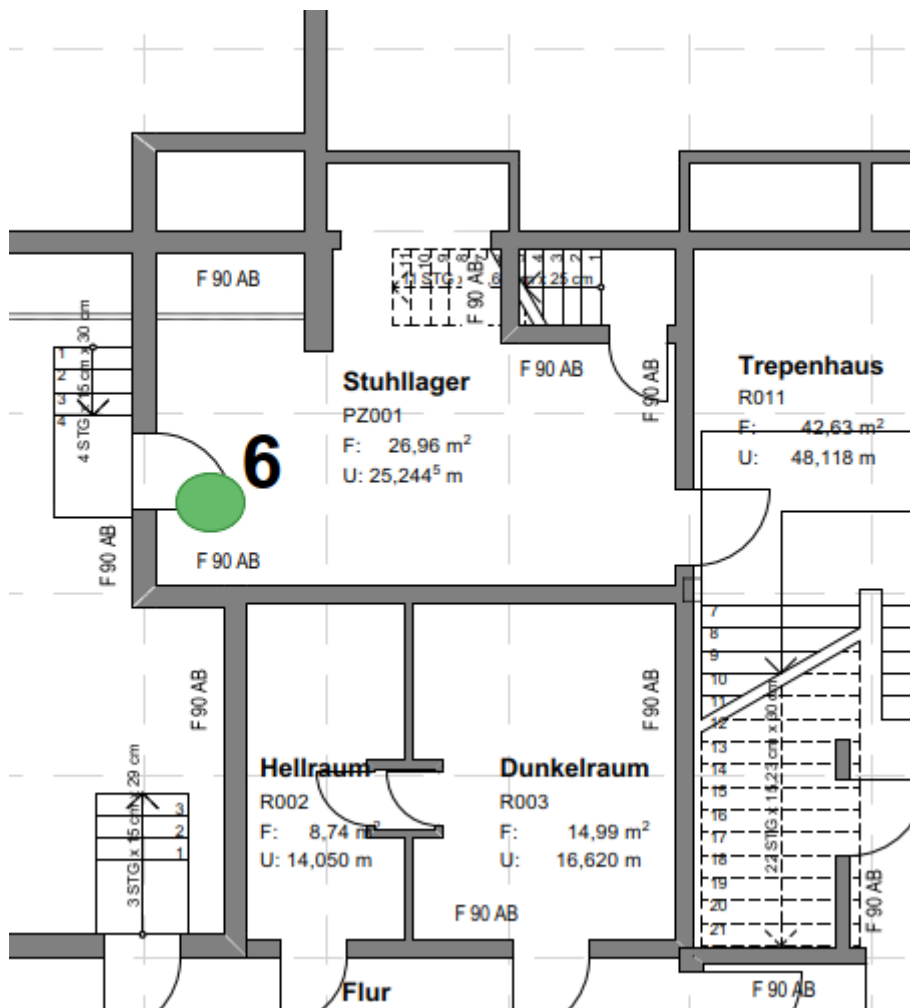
Grundrissausschnitt Ebene 0 (grün = ohne Befund, rot = Befund)
